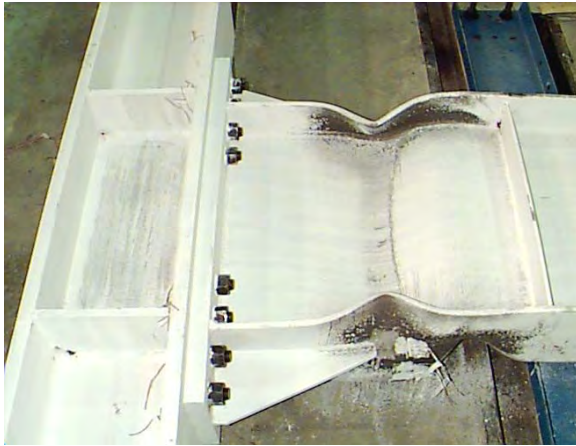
Conexión después de finalizada la prueba, se observa el pandeo en ambos patines de la viga. (Sumner et al. 2000).
